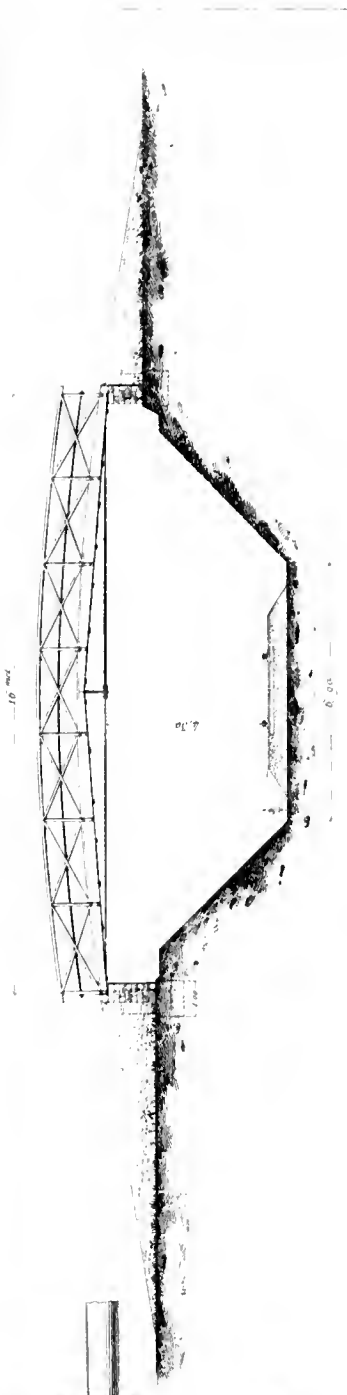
PLAN ET ELEVATION SUIVANT C-D (Fig. 1 et 4)
